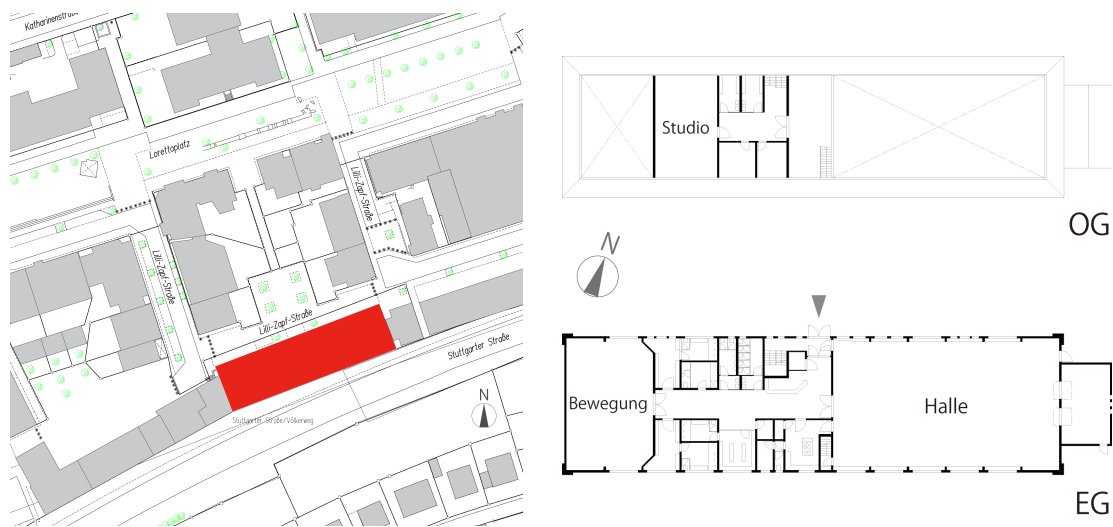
Lageplan [Links] (Pläne von Universitätsstadt Tübingen)
